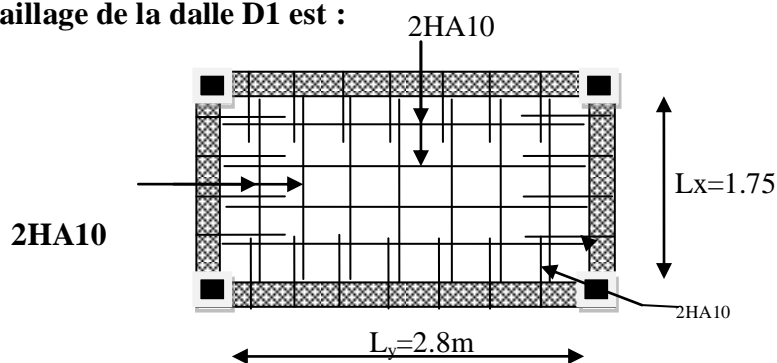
schéma de ferrailage de la dalle sur 4 appuis.
